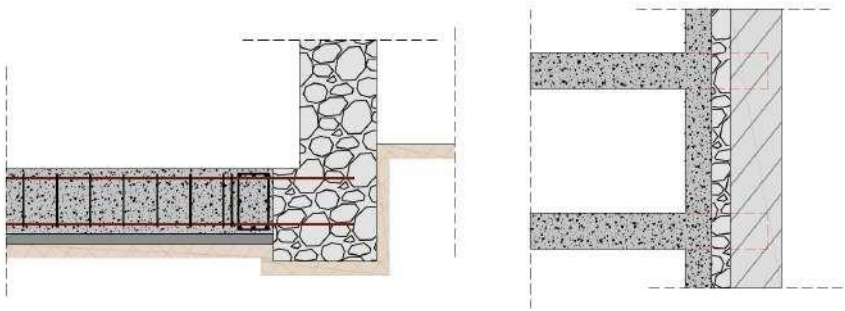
Sección zapata corrida. Refuerzo Tipo 2. Fuente propia
